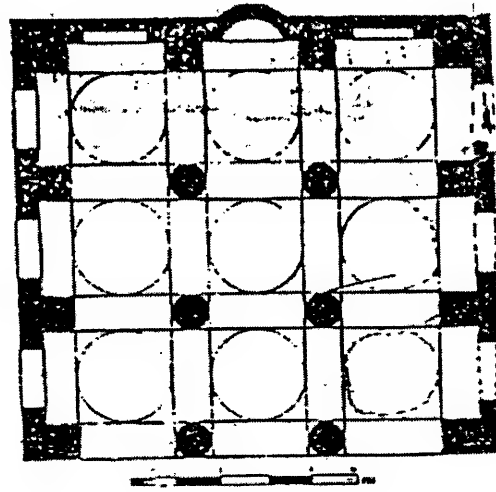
المسقط الأفقي لمسجد بوفتاتة في سوسة (٢٢٣-٢٢٦ هـ / ٨٣٨-٨٤١ م).
